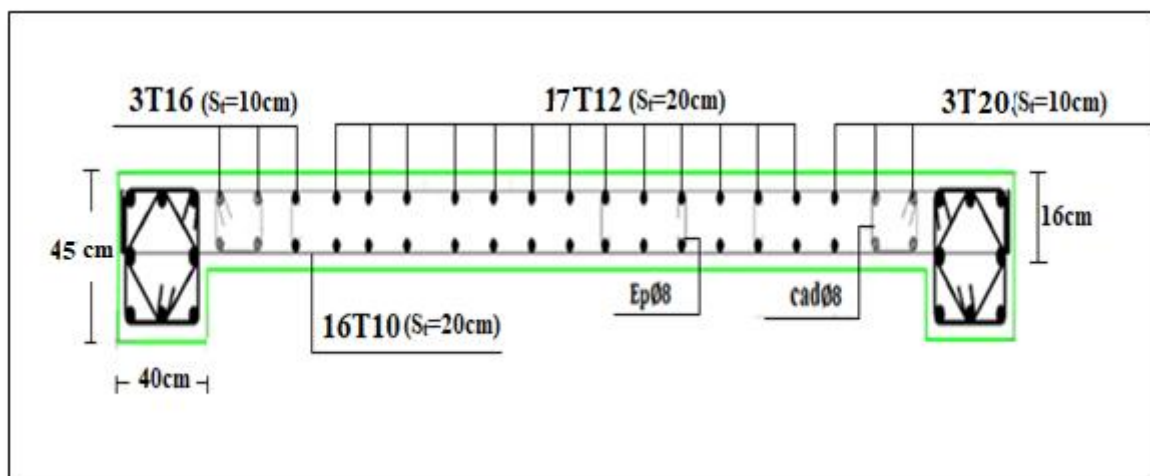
Schéma de ferrailage de Voile longitudinale.
